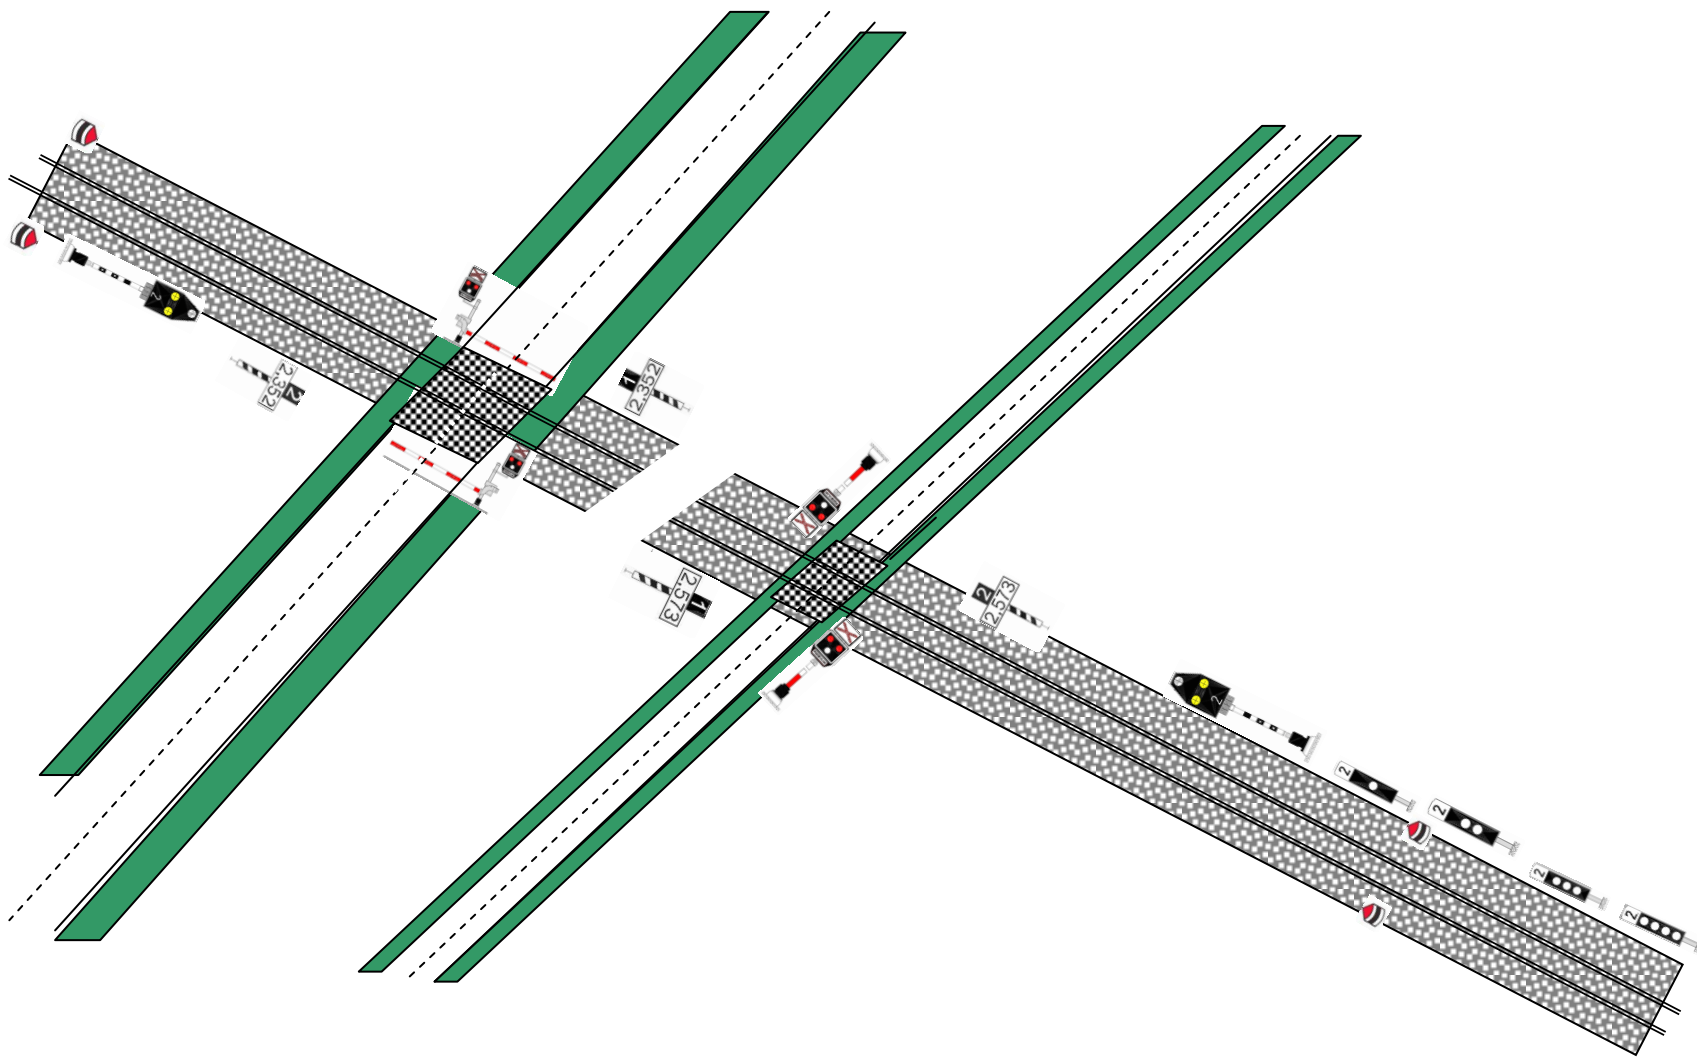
Návesti pri POTR na priecestí umiestňované z dôvodu rozhľadových pomerov
